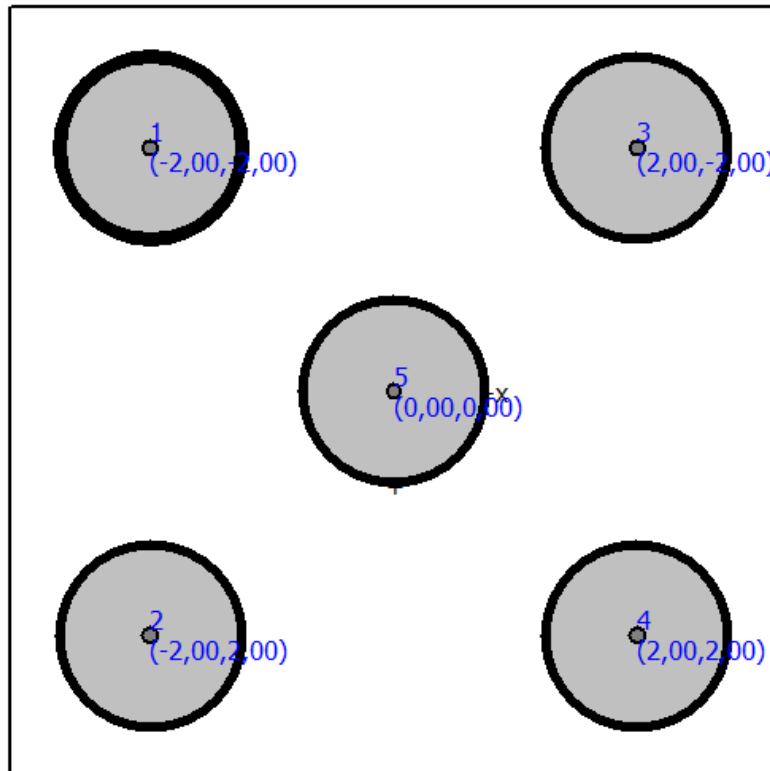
Rozmístění pilot průměru 1200 mm pod patkou
